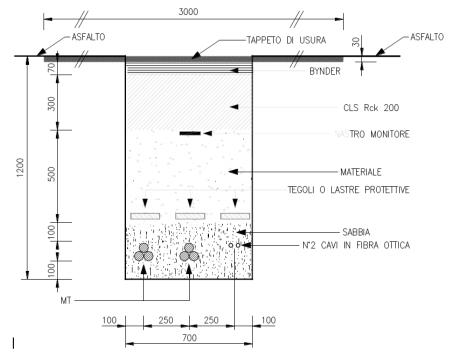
Sezione tipica di posa della linea in cavo su sede stradale
